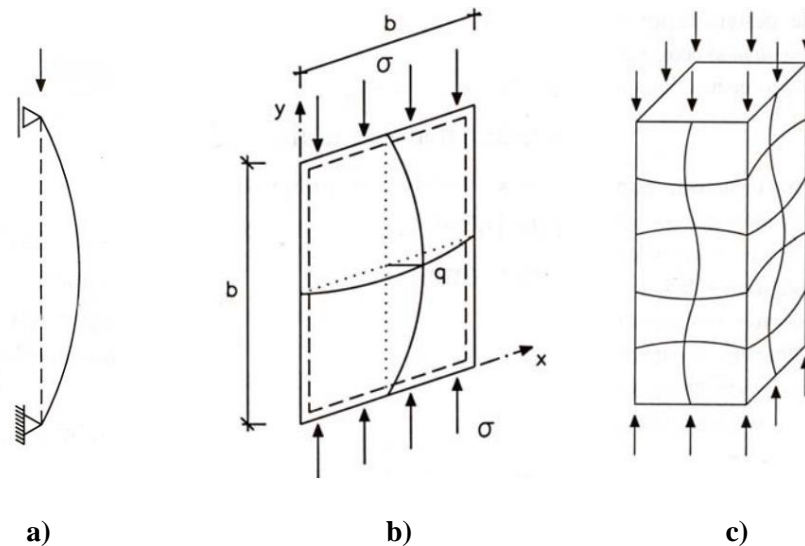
Tipos de estruturas sujeitas a instabilidade bifurcacional: a) coluna; b) placa; c) coluna tubular (Veríssimo, 2008).
